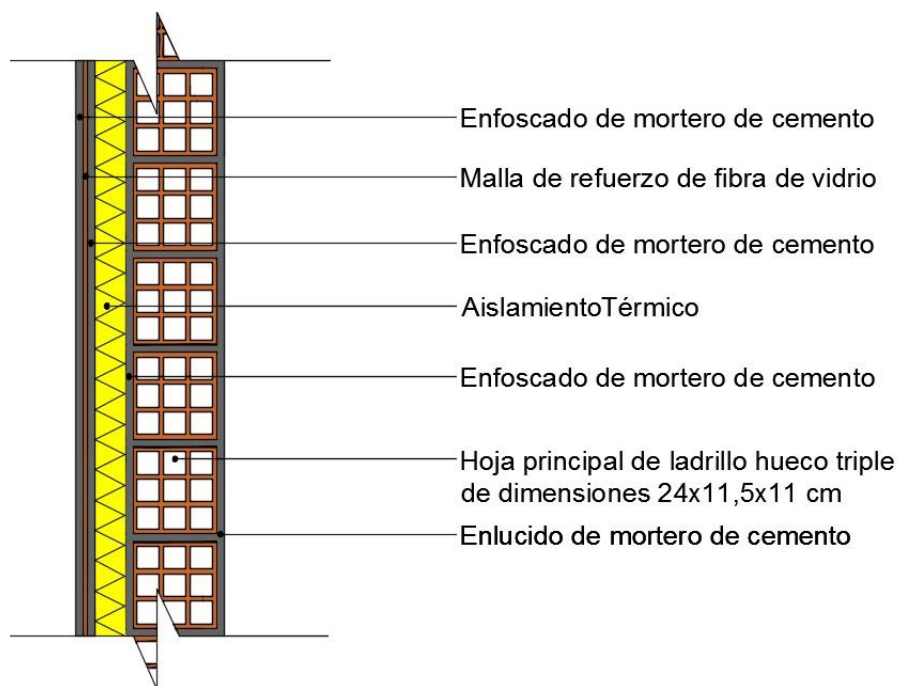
Sección constructiva del sistema SATE del cerramiento de medianería y patios
